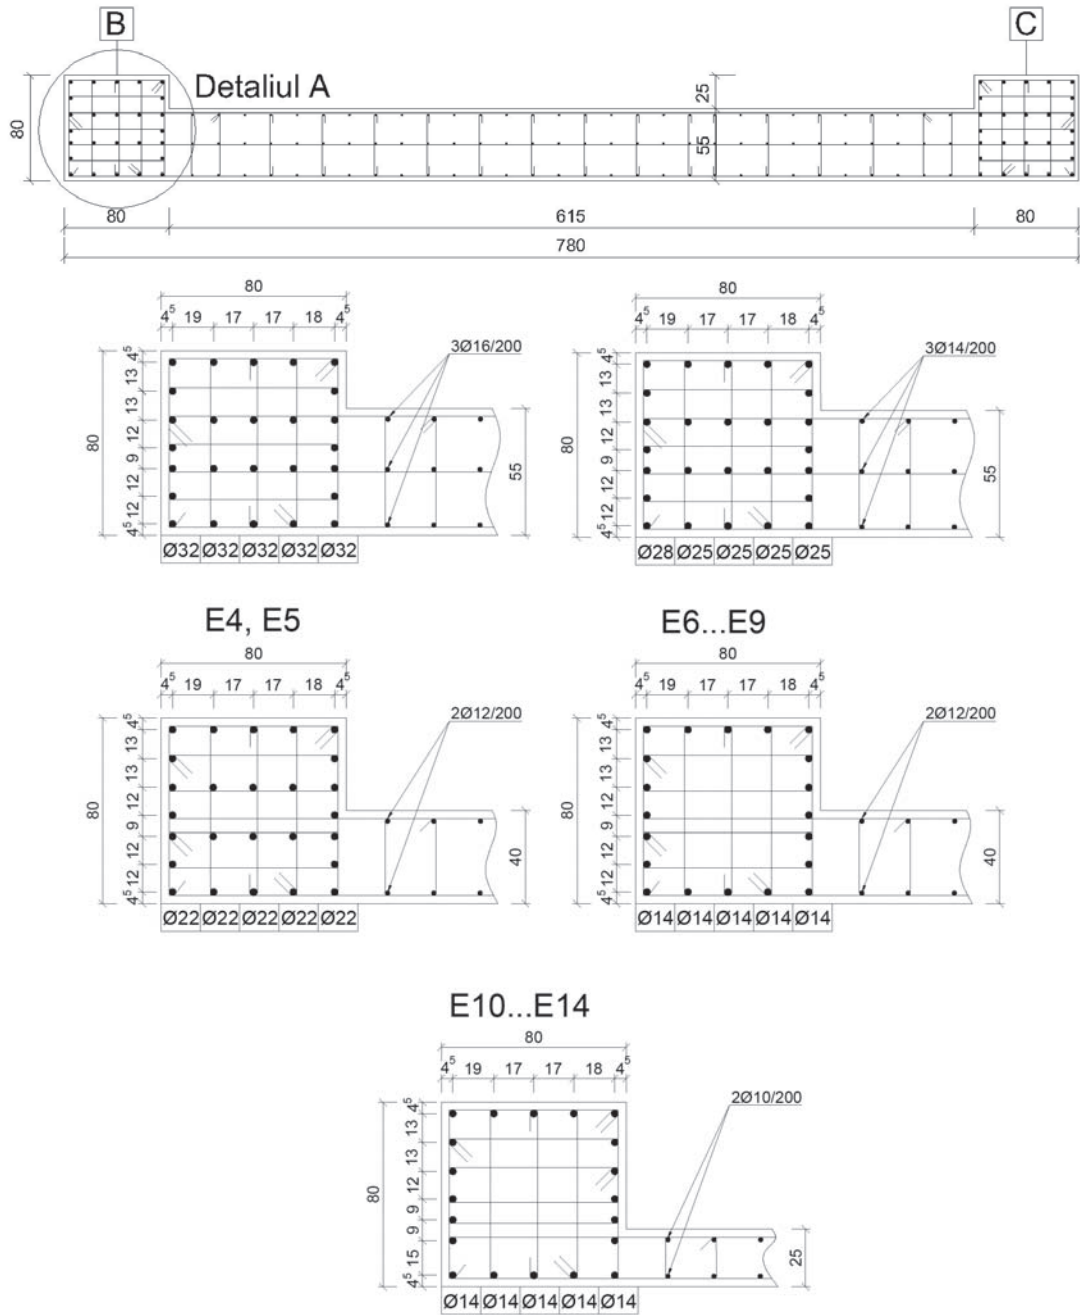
Armare longitudinală perete cuplat transversal P1, P2, P5, P6, clasa de ductilitate M
